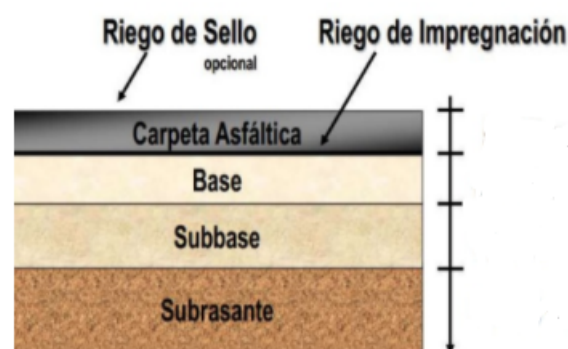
Estructura de un pavimento Flexible. Recuperado de: Proceso constructivo del Pavimento flexible. Civilneting (2019)
